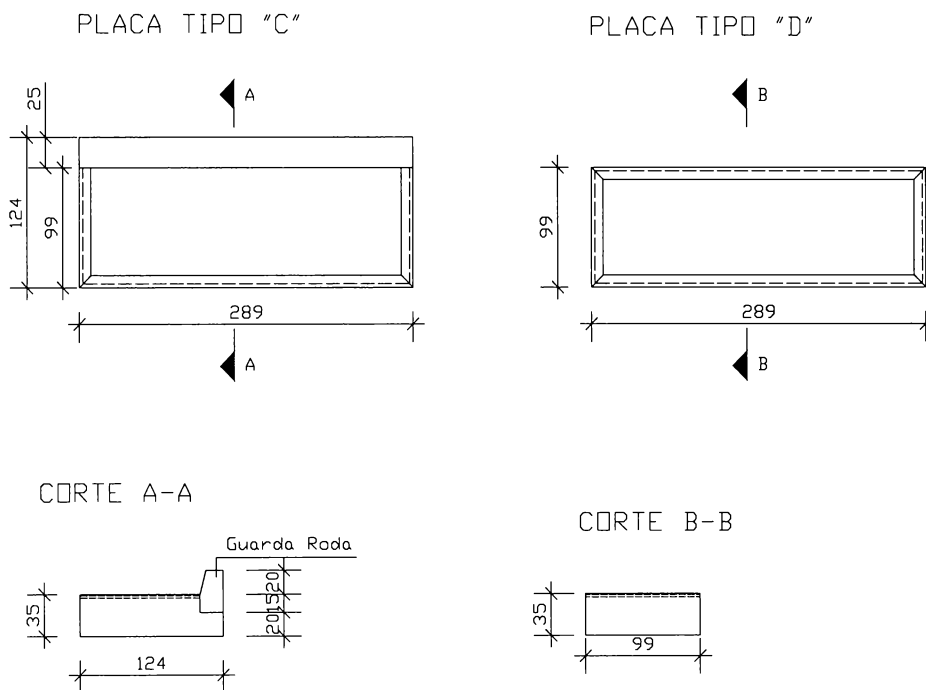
ANEXO – VISTA EM PLANTA DA PONTE 2.5.3 FONTE: Extraído do projeto executivo
